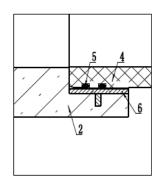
含电力、通信管线分支口混凝土节点与竹缠绕管廊廊体 图5.4.2-5 连接处局部放大图 连接示意图
